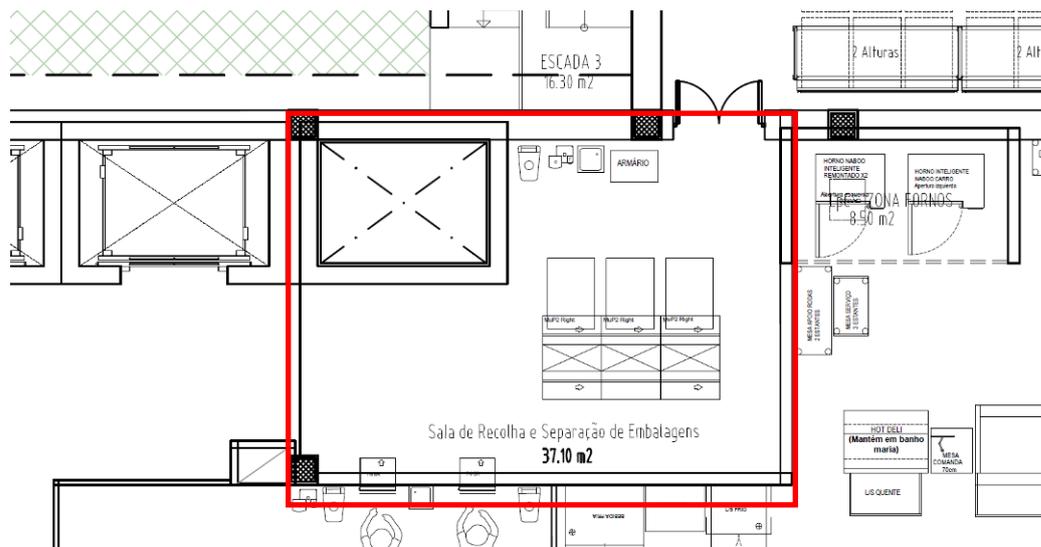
Sala de recolha e separação de embalagens (extrato da planta de implantação – piso 0)
